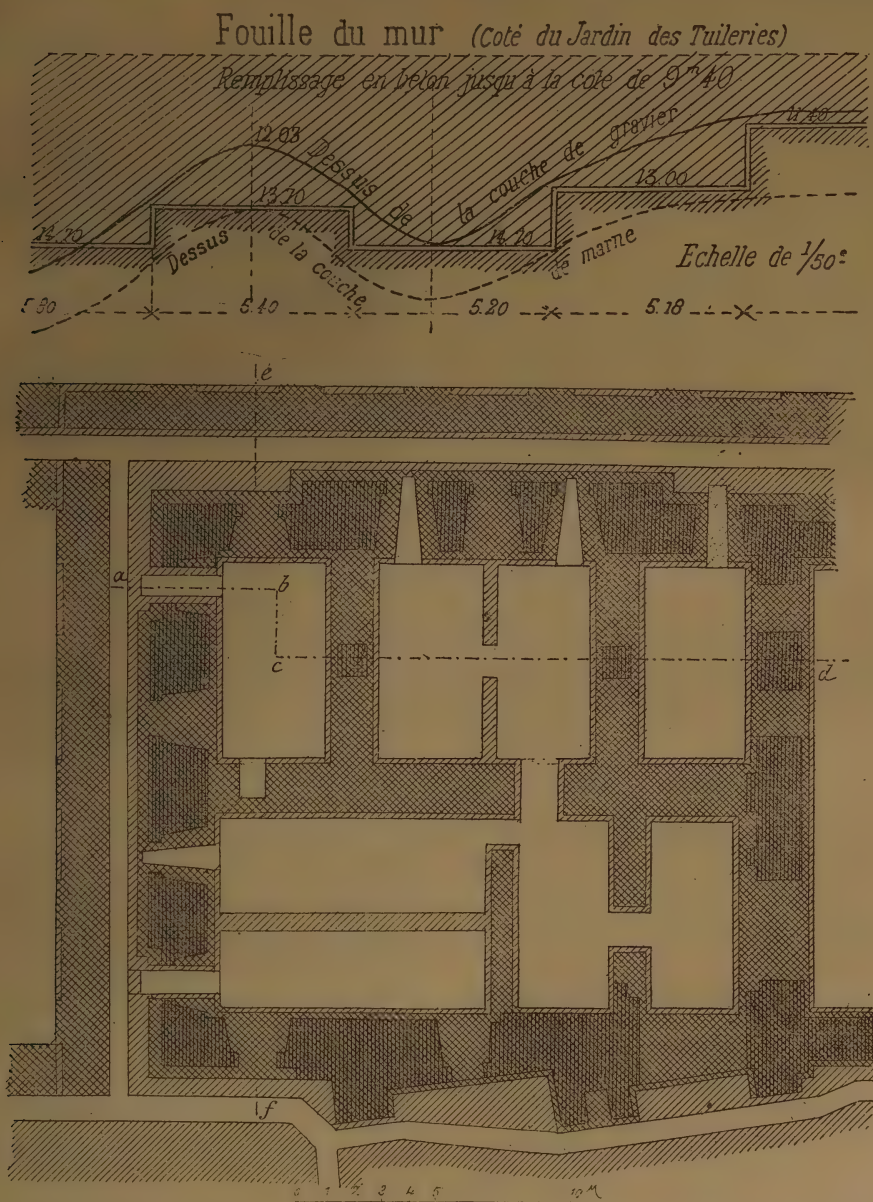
Pavillon de Flore. — Plans des fondations et tracé de la fouille du mur de soutènement.
